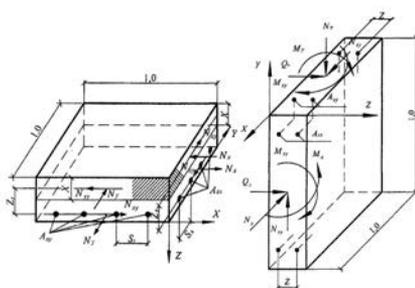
Схемы усилий к расчету плоских элементов плит и стен по СП 63.13330.2012
